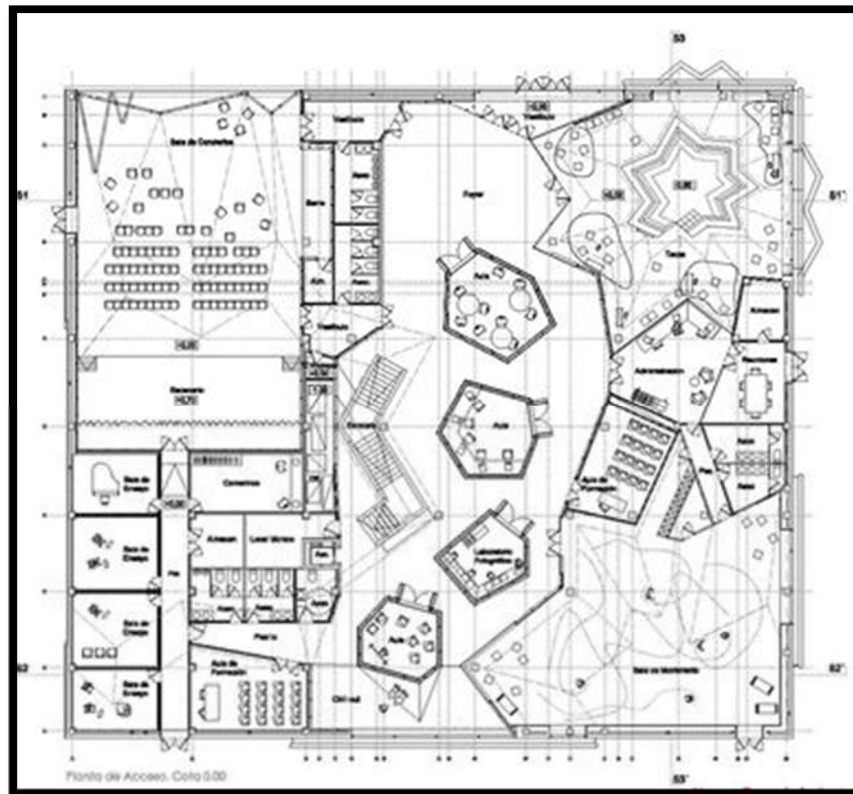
Planta Arq. 1º nivel Centro Juvenil “Casagrande” En Rivas Vaciamadrid/
